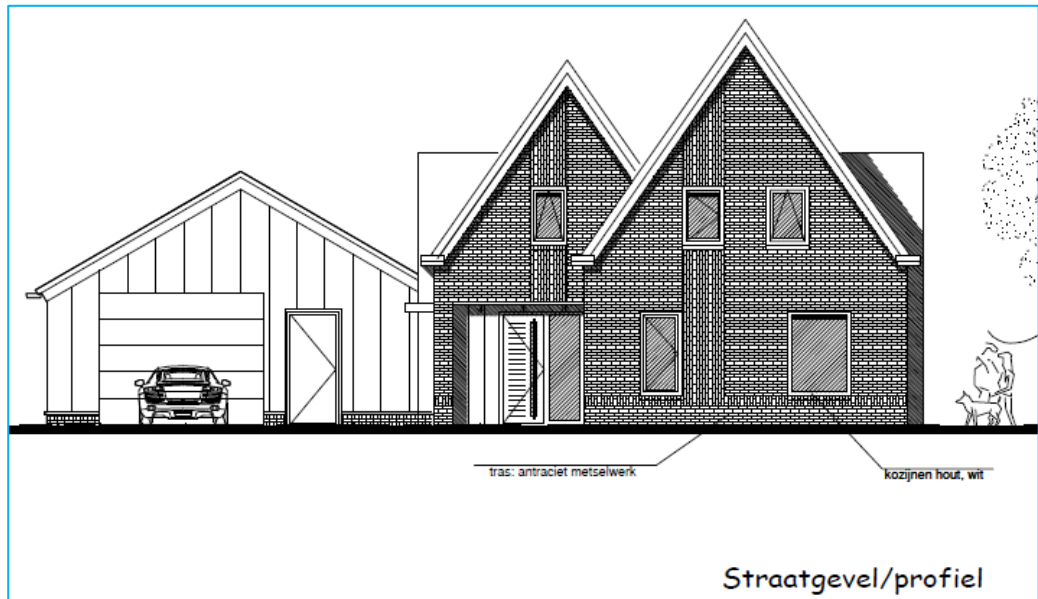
Weergave profiel van de bebouwing gezien vanaf de Graauwedijk.
